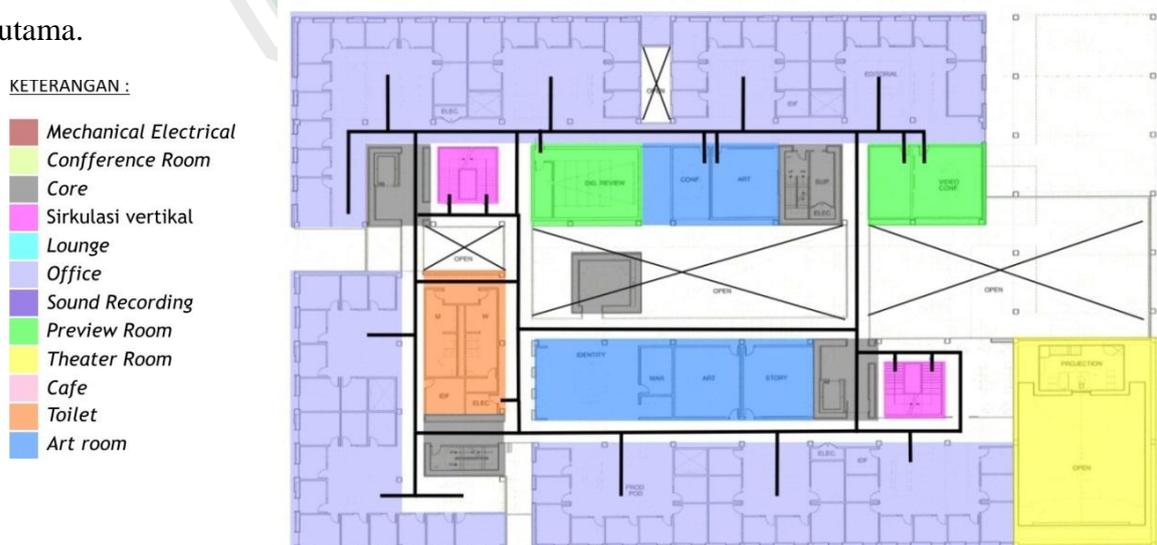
Detail Sirkulasi Denah Lantai 2
